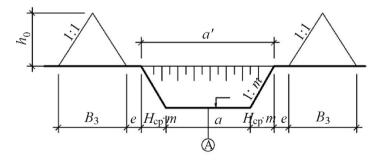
Расчетная схема двухстороннего размещения отвала при разработке траншеи (котлована)
